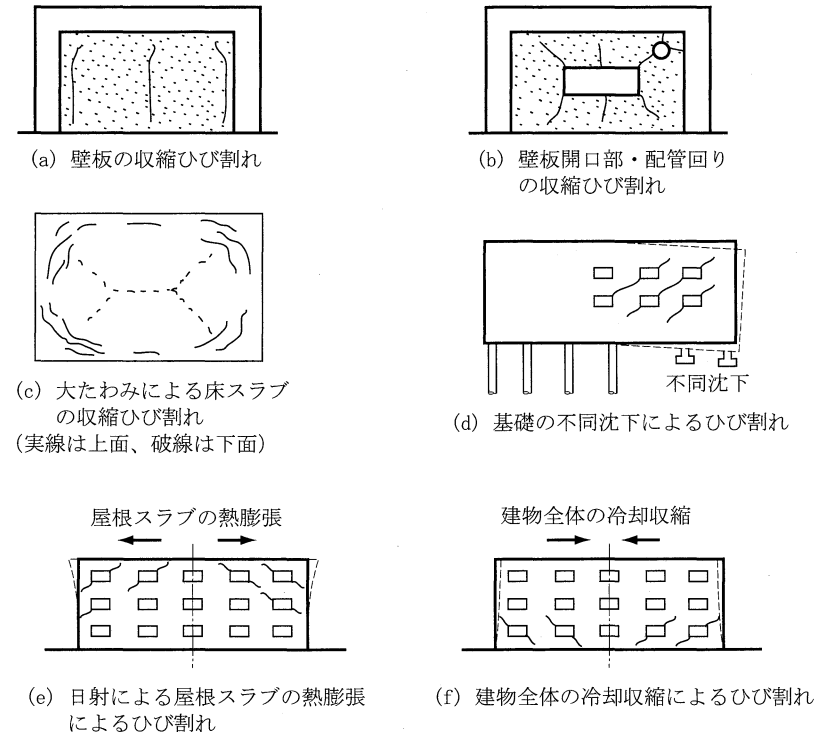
硬化コンクリートのひび割れの原因と対策 (Mercer)
